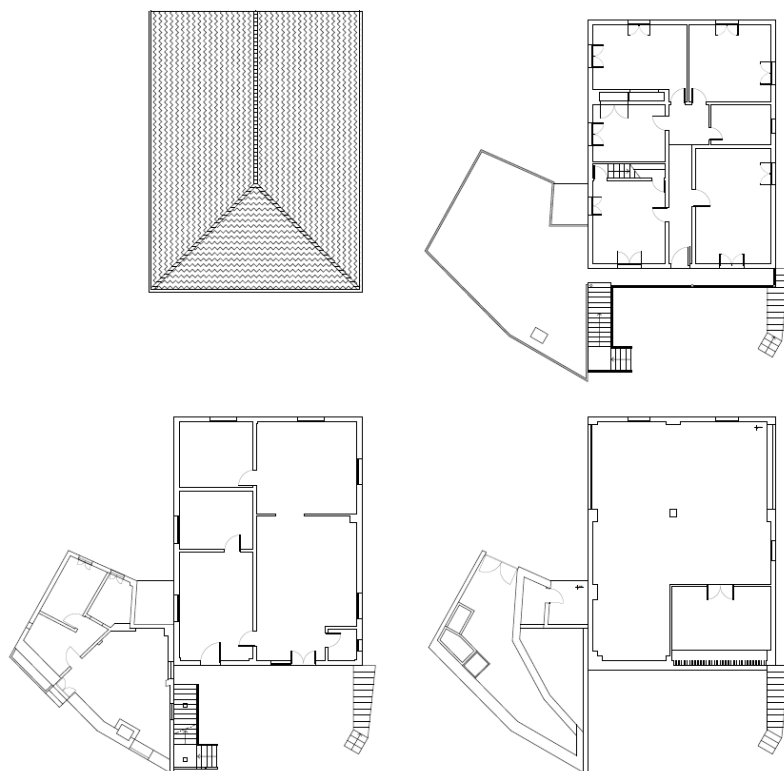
Plantas existentes (cobertura, 1º andar, rés do chão, cave)
